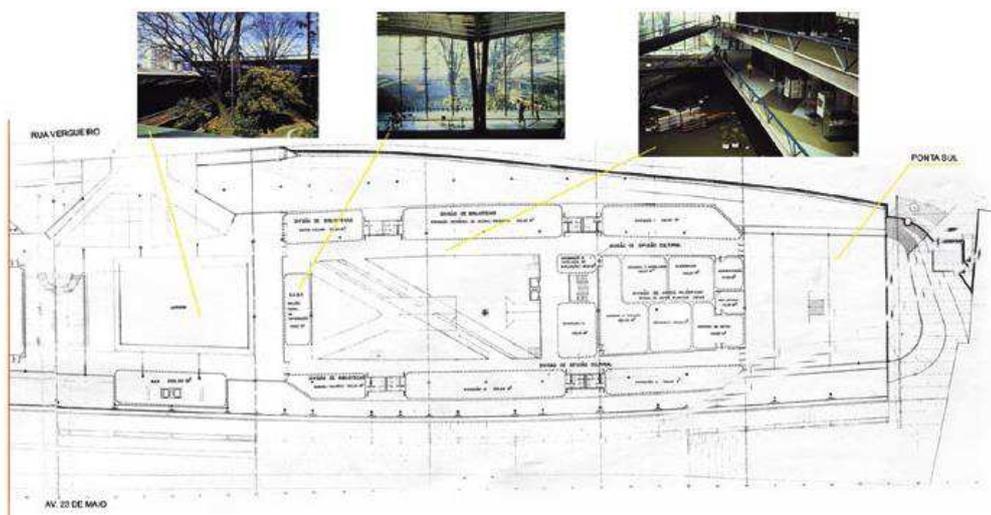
Planta baixa do Centro Cultural São Paulo – ponta sul
